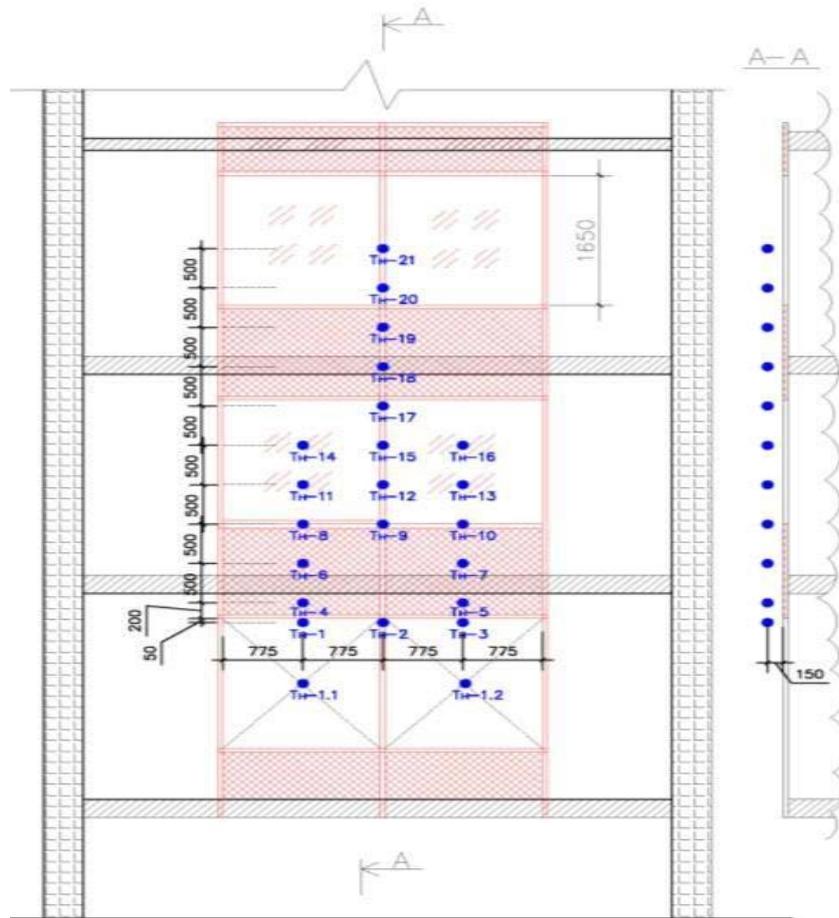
Схема розстановки термопар зовні будівлі по вертикалі фасаду
